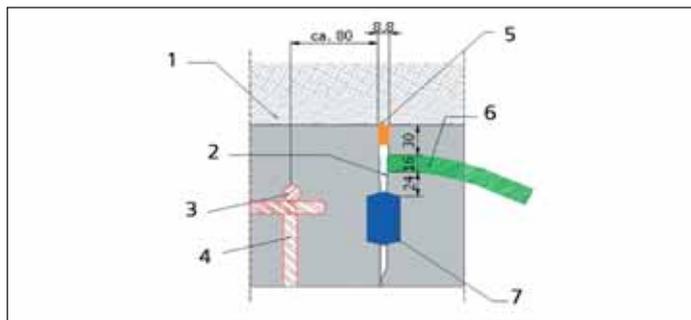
Конструкция стыка блока с вмонтированными инъекционными шлангами: 1 — заполняющий раствор (со стороны грунта); 2 — инжектируемый шов между уплотнительной лентой и уплотнительным профилем; 3 — наружная несущая арматура; 4 — поперечный хомут; 5 — наружная уплотнительная лента 20×14 мм; 6 — инъекционный шланг длиной около 1,4 м, закрепленный на хомутах; 7 — уплотнительный профиль
